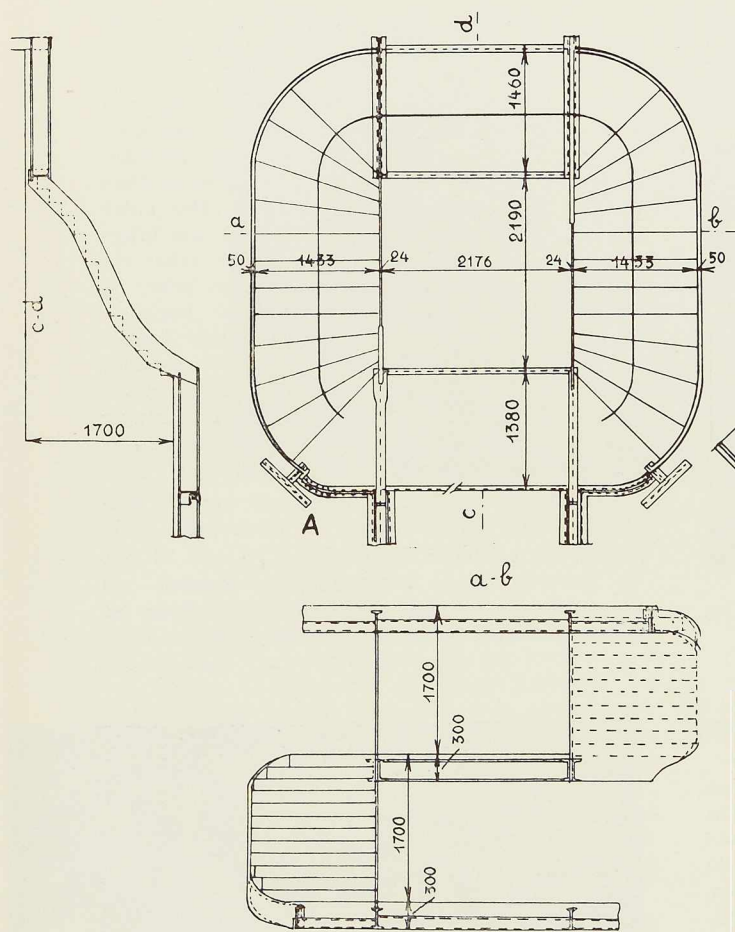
Construction de l'escalier principal. Le limon extérieur repose sur un élément d'appui solide de la poutre horizontale oblique de plancher.
